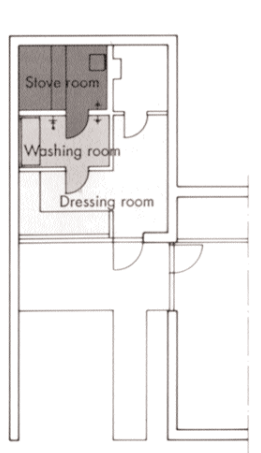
Компонированный план домашней сауны. Масштаб 1:200
